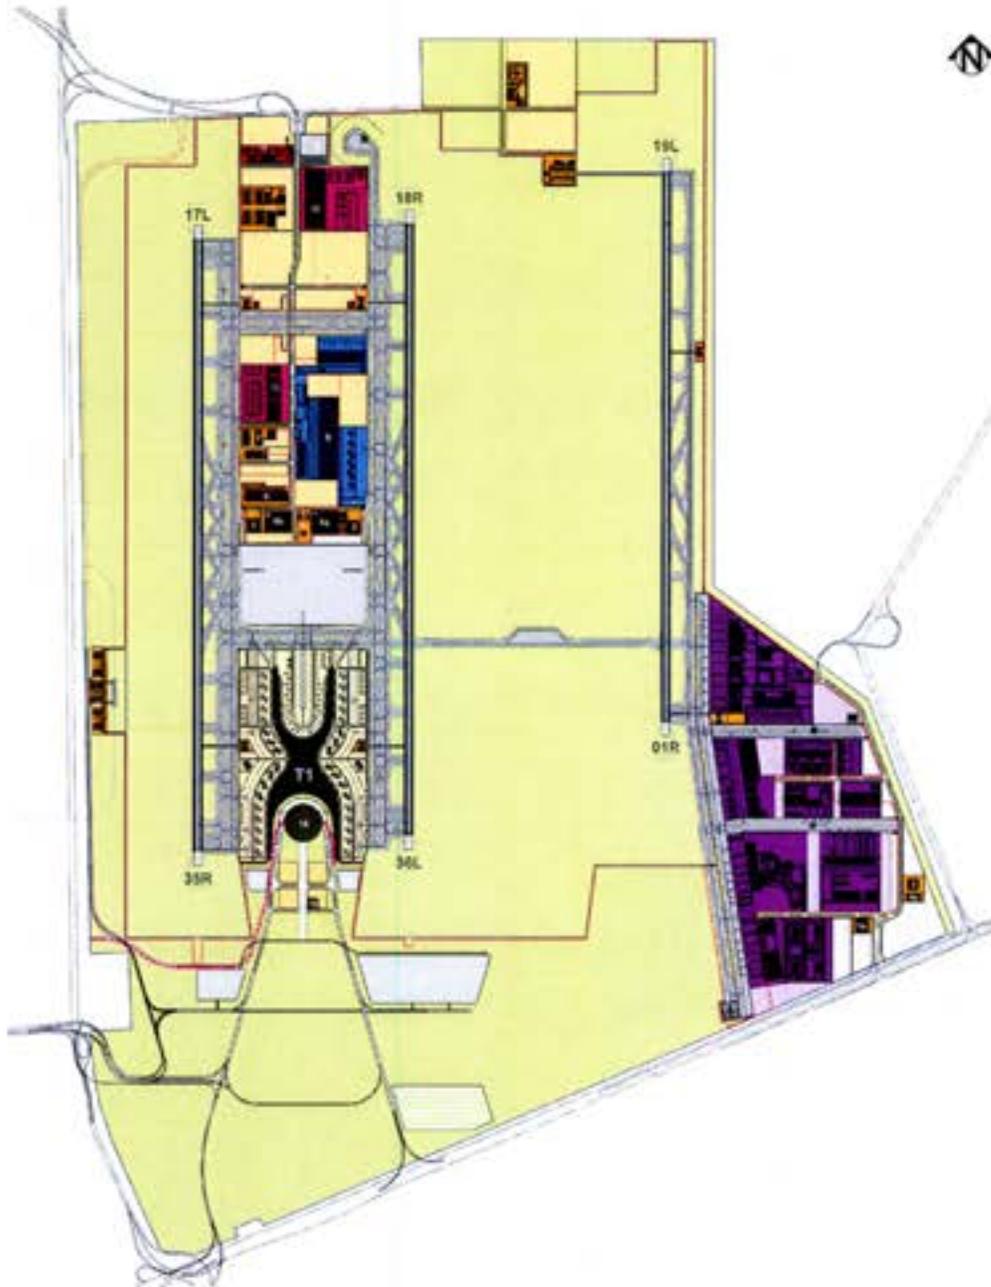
Esquema del Aeropuerto | Plan Maestro 2020
